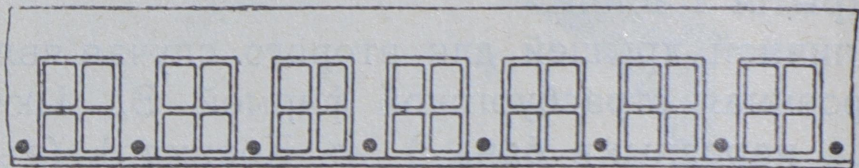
Перекрытіе изъ полыхъ тѣлъ.
